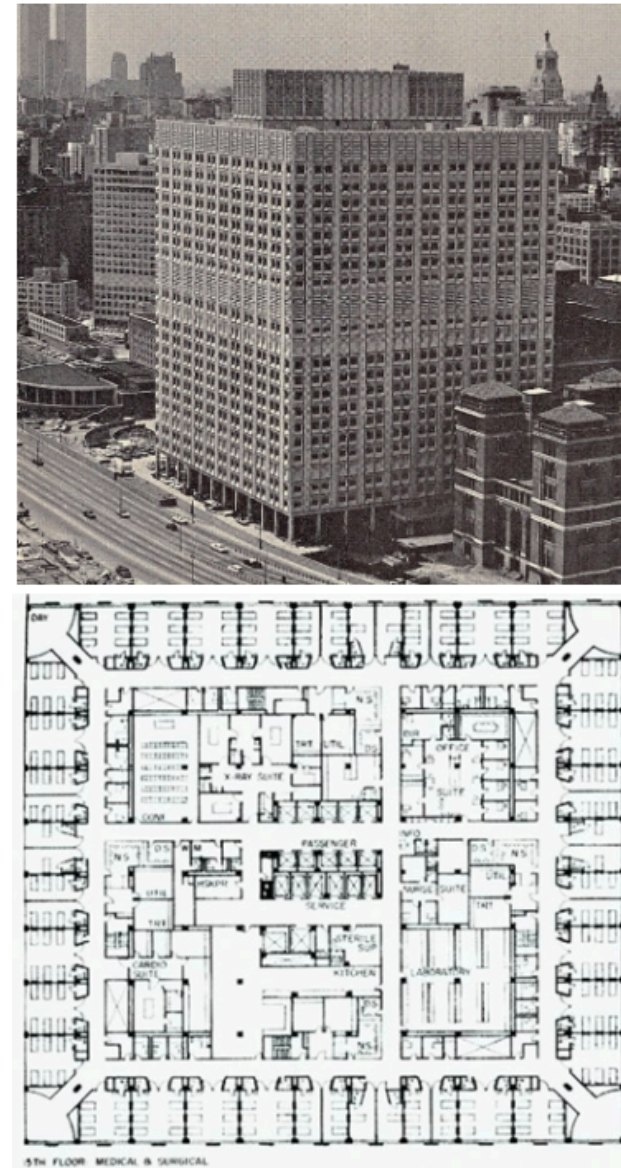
Imagem e planta do 15º pavimento do Hospital Bellevue, New York City, 1964, (VERDERBER; FINE, 2000, p. 32). Fonte da imagem: <https://www.nycurbanism.com/brutalnyc/bellevue-new-building>.
